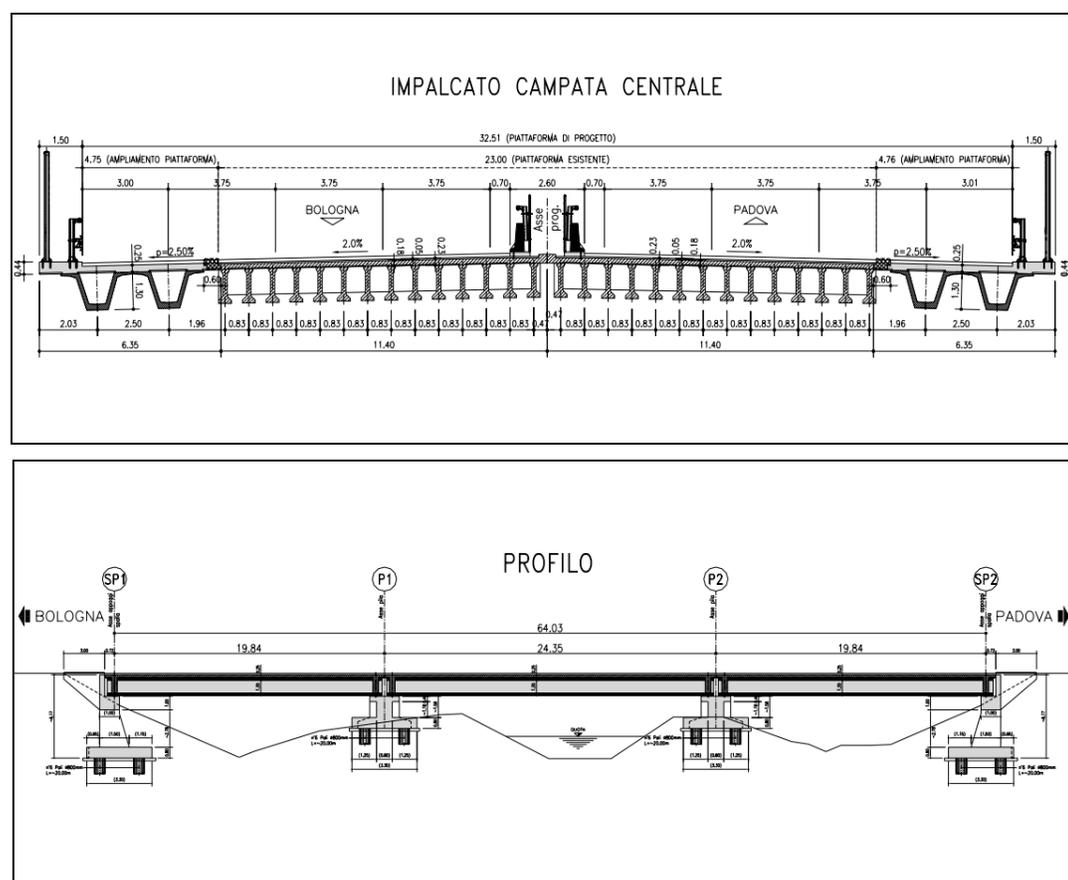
Sezione dell'impalcato e profilo del ponte sul canale Rivella
